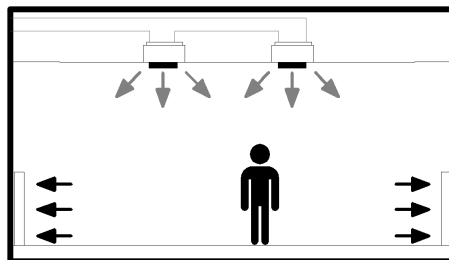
Kolbenlüftung II (Werkbild: FfH – Fachplanung für Haustechnik)
